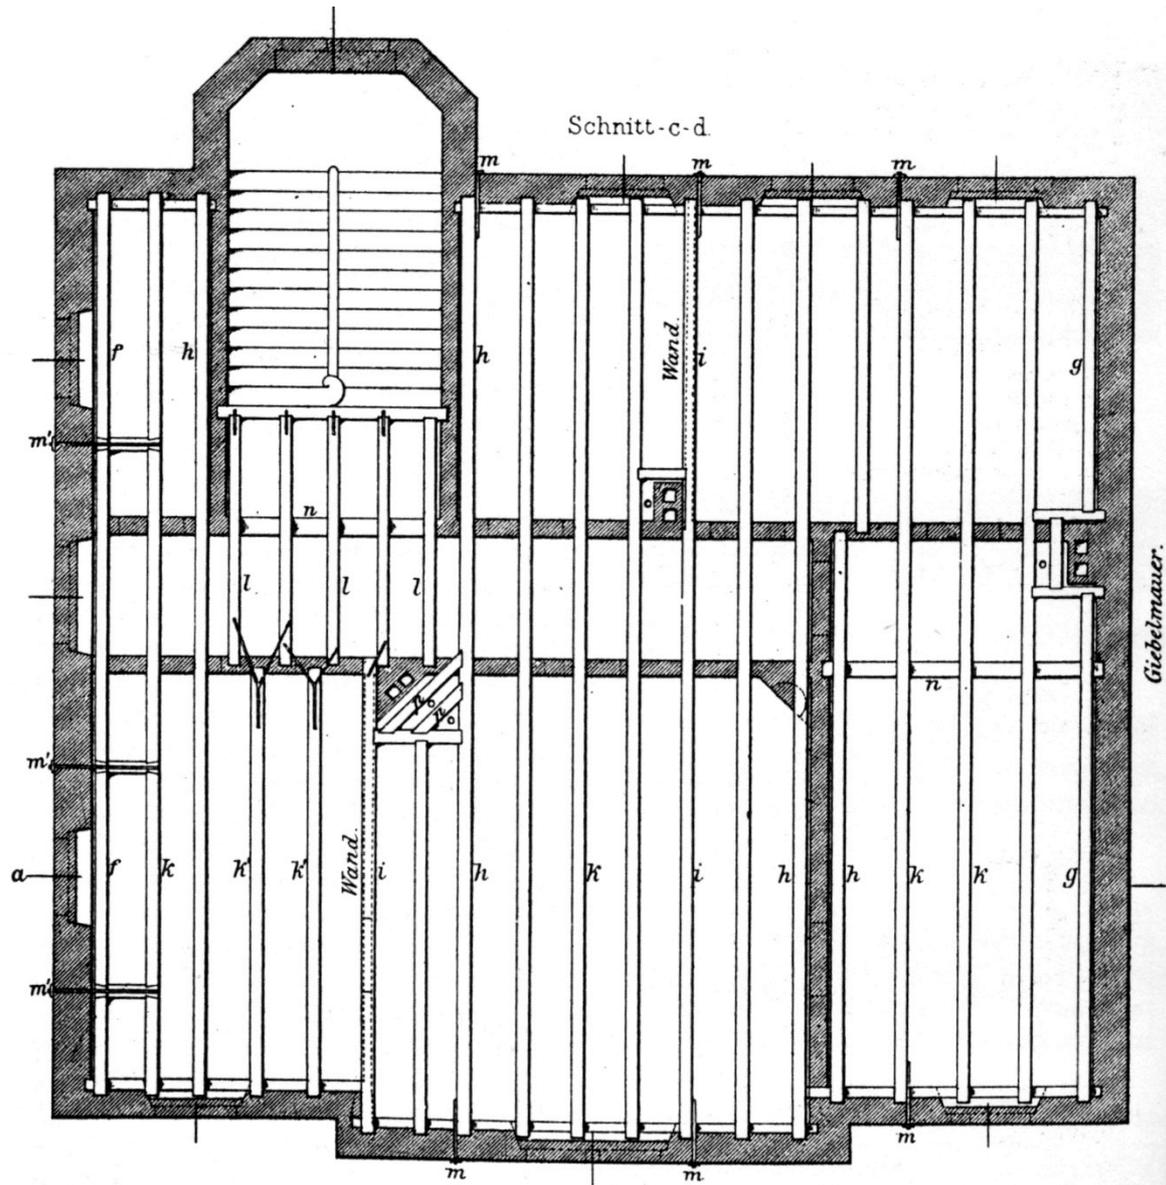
typische Holzbalkendecke aus Atlas Sanierung S. 145
